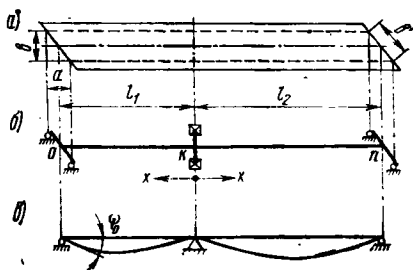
Схемы для расчета неразрезного косоугольного пролетного строения
